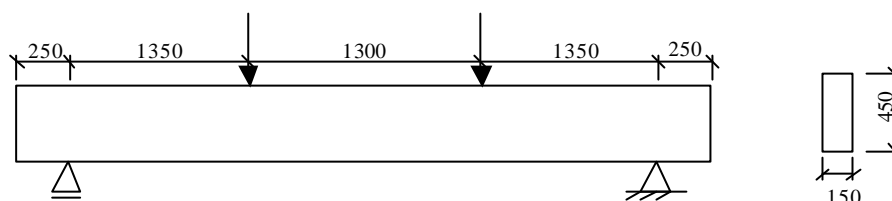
Geometria e carregamento das vigas de Carneiro (1998)
